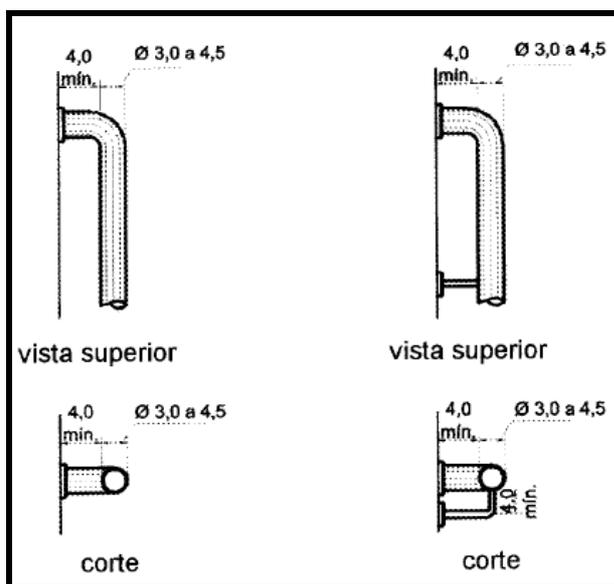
Barras de apoio (dimensões em centímetros).
